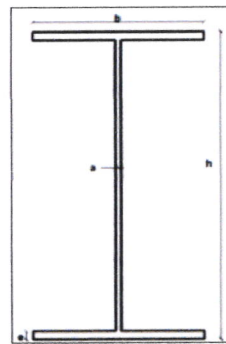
poutre IPN 400 ; source auteurs 2018.
